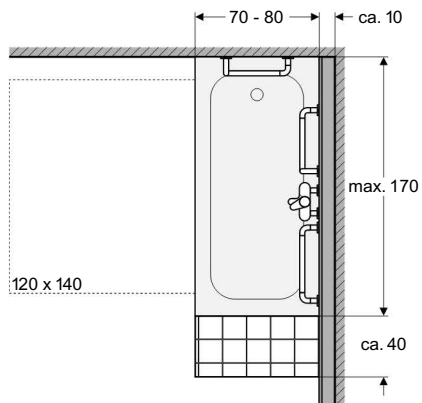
Badewanne, Grundriss mit Bewegungsfläche für Rollstuhlfahrer
